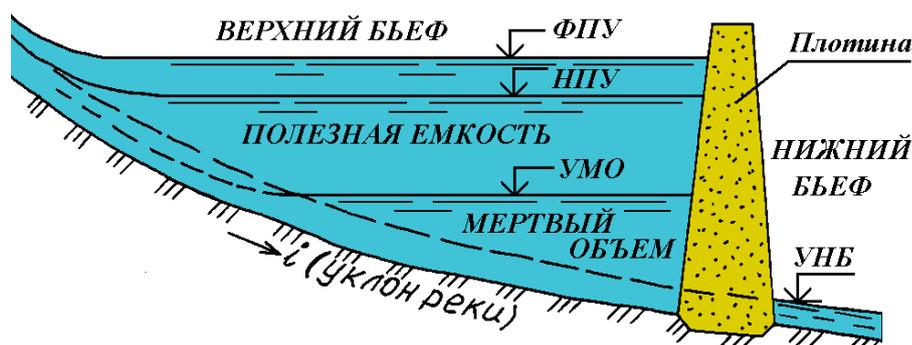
Схема создания грунтовой плотиной водохранилища с основными расчётными уровнями
